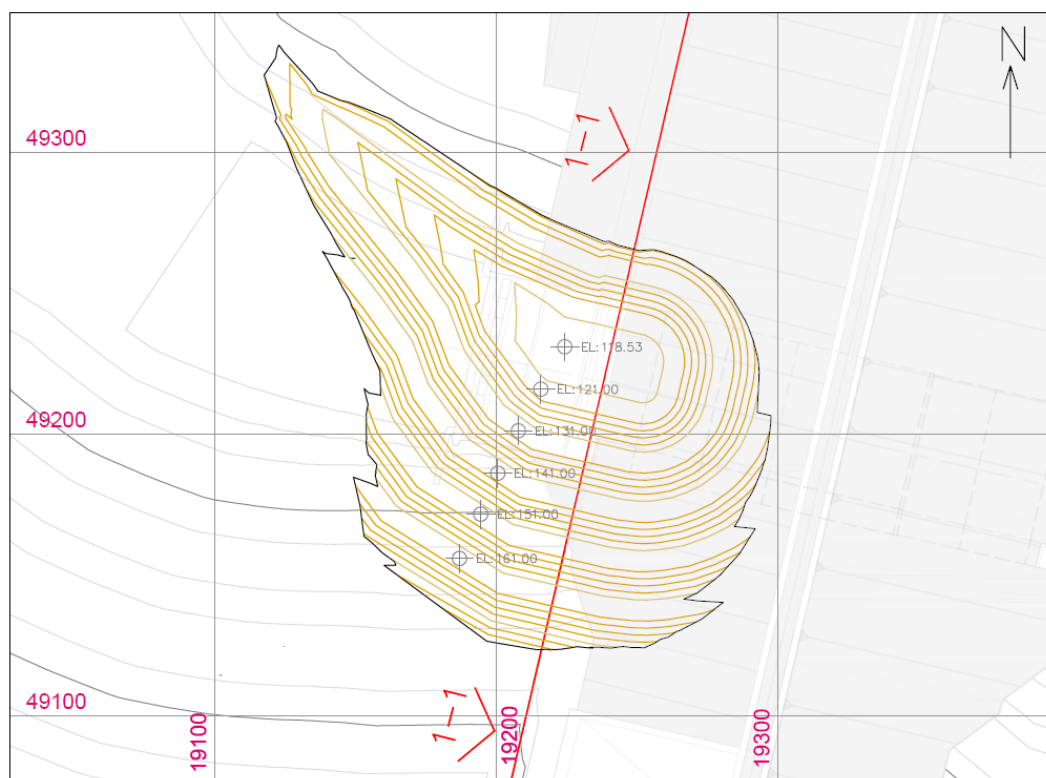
Planta Excavación Inicial en Estructura de Desvío
